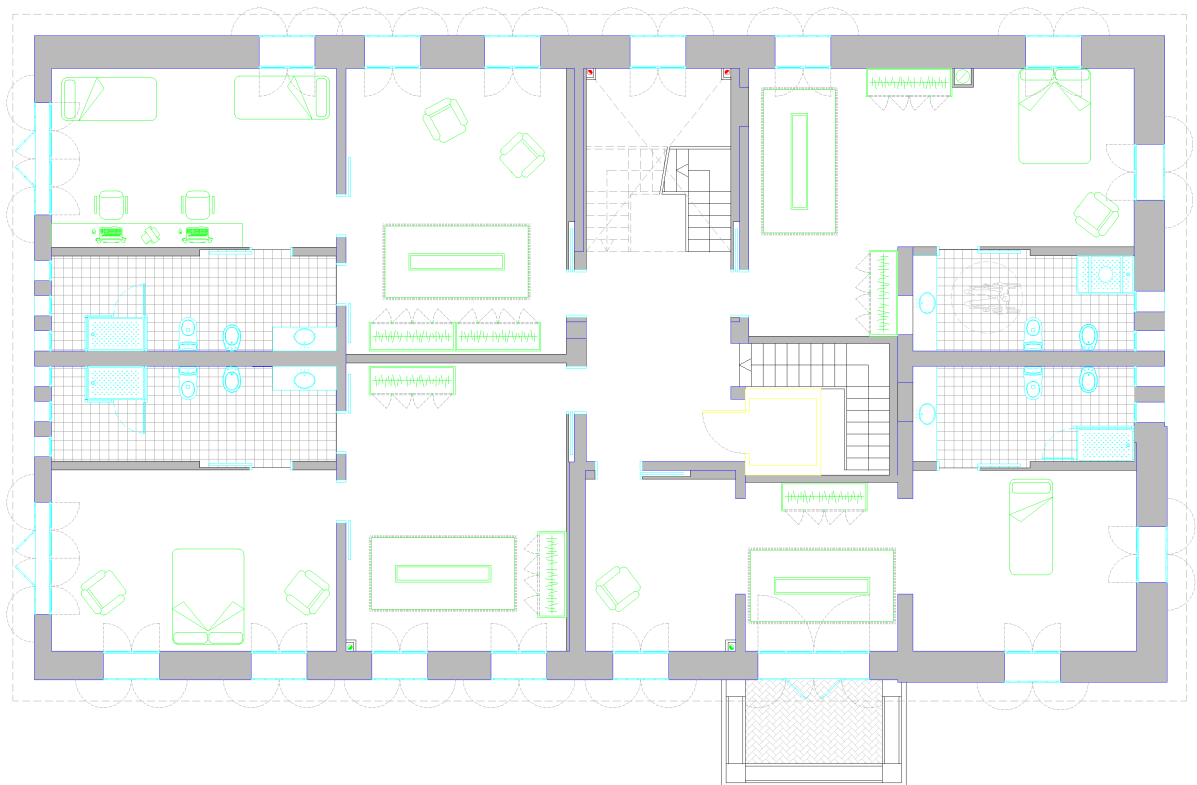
Plano planta primera (Fuente: Propia)
